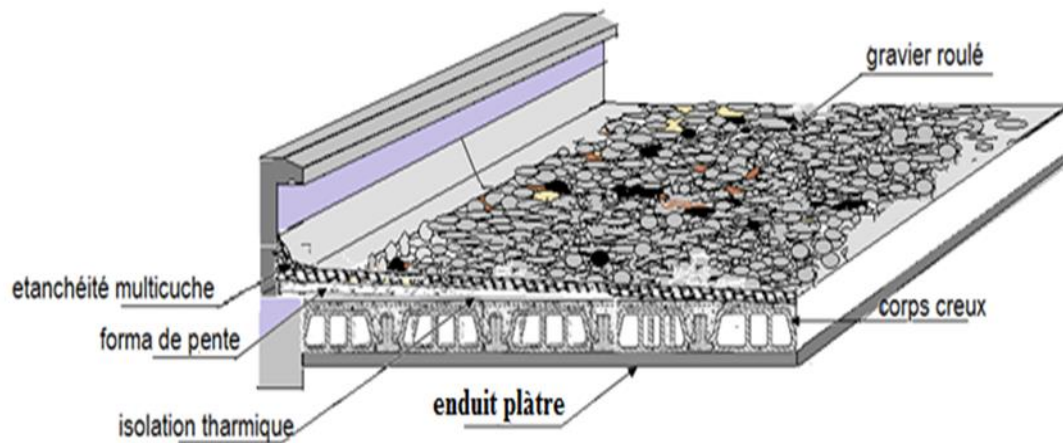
coupe de Plancher Terrasse Inaccessible
